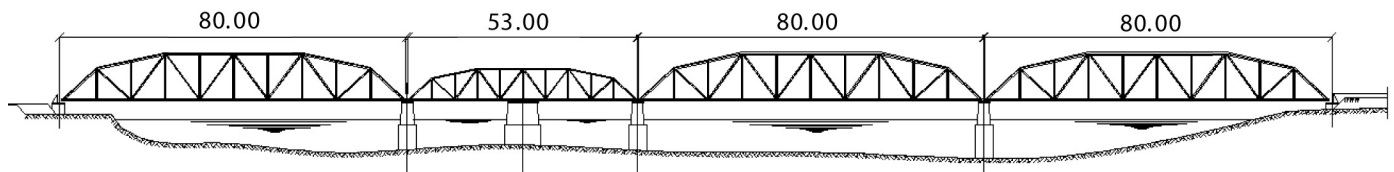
a : Elévation et coupe longitudinale du pont-rails d'Edfina.
